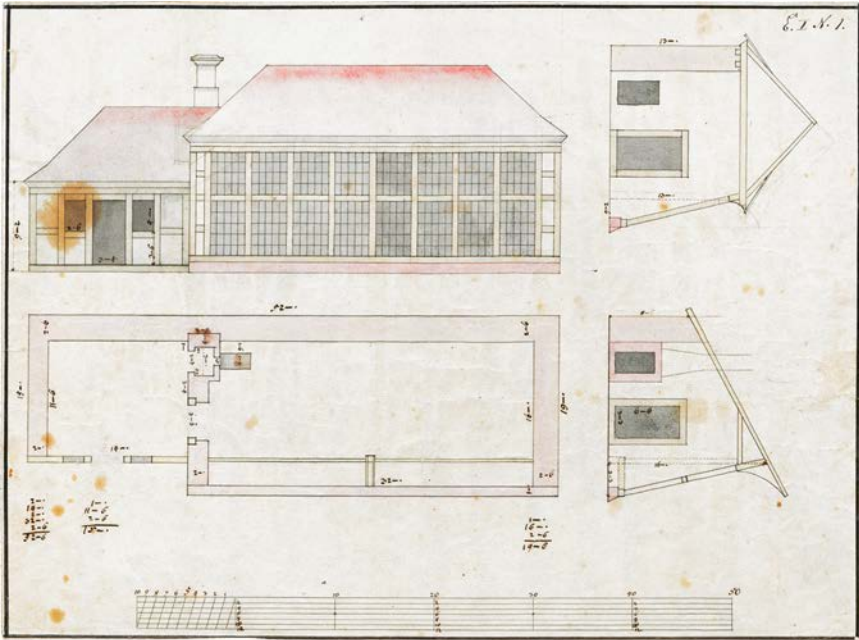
Querschnitte und Grundriss des Gewächshauses (Orangerie) im Baumgarten der Franckeschen Stiftungen in Halle, ca. 1744
